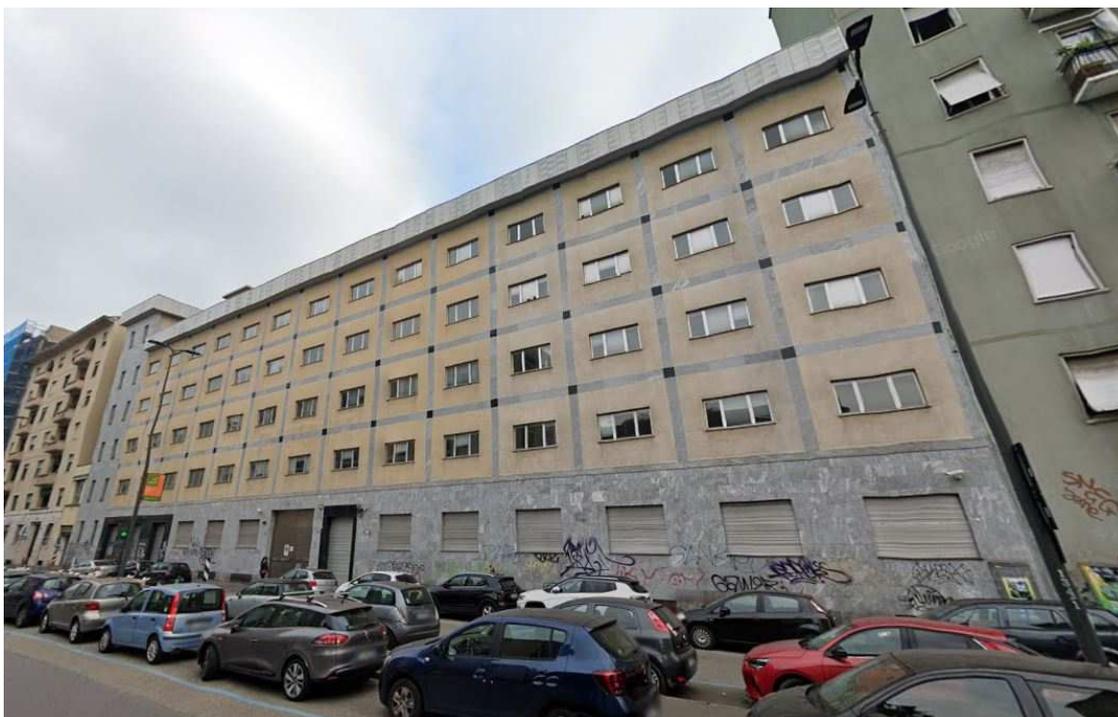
Ante opera - prospetto principale su Via Melchiorre Gioia 124
